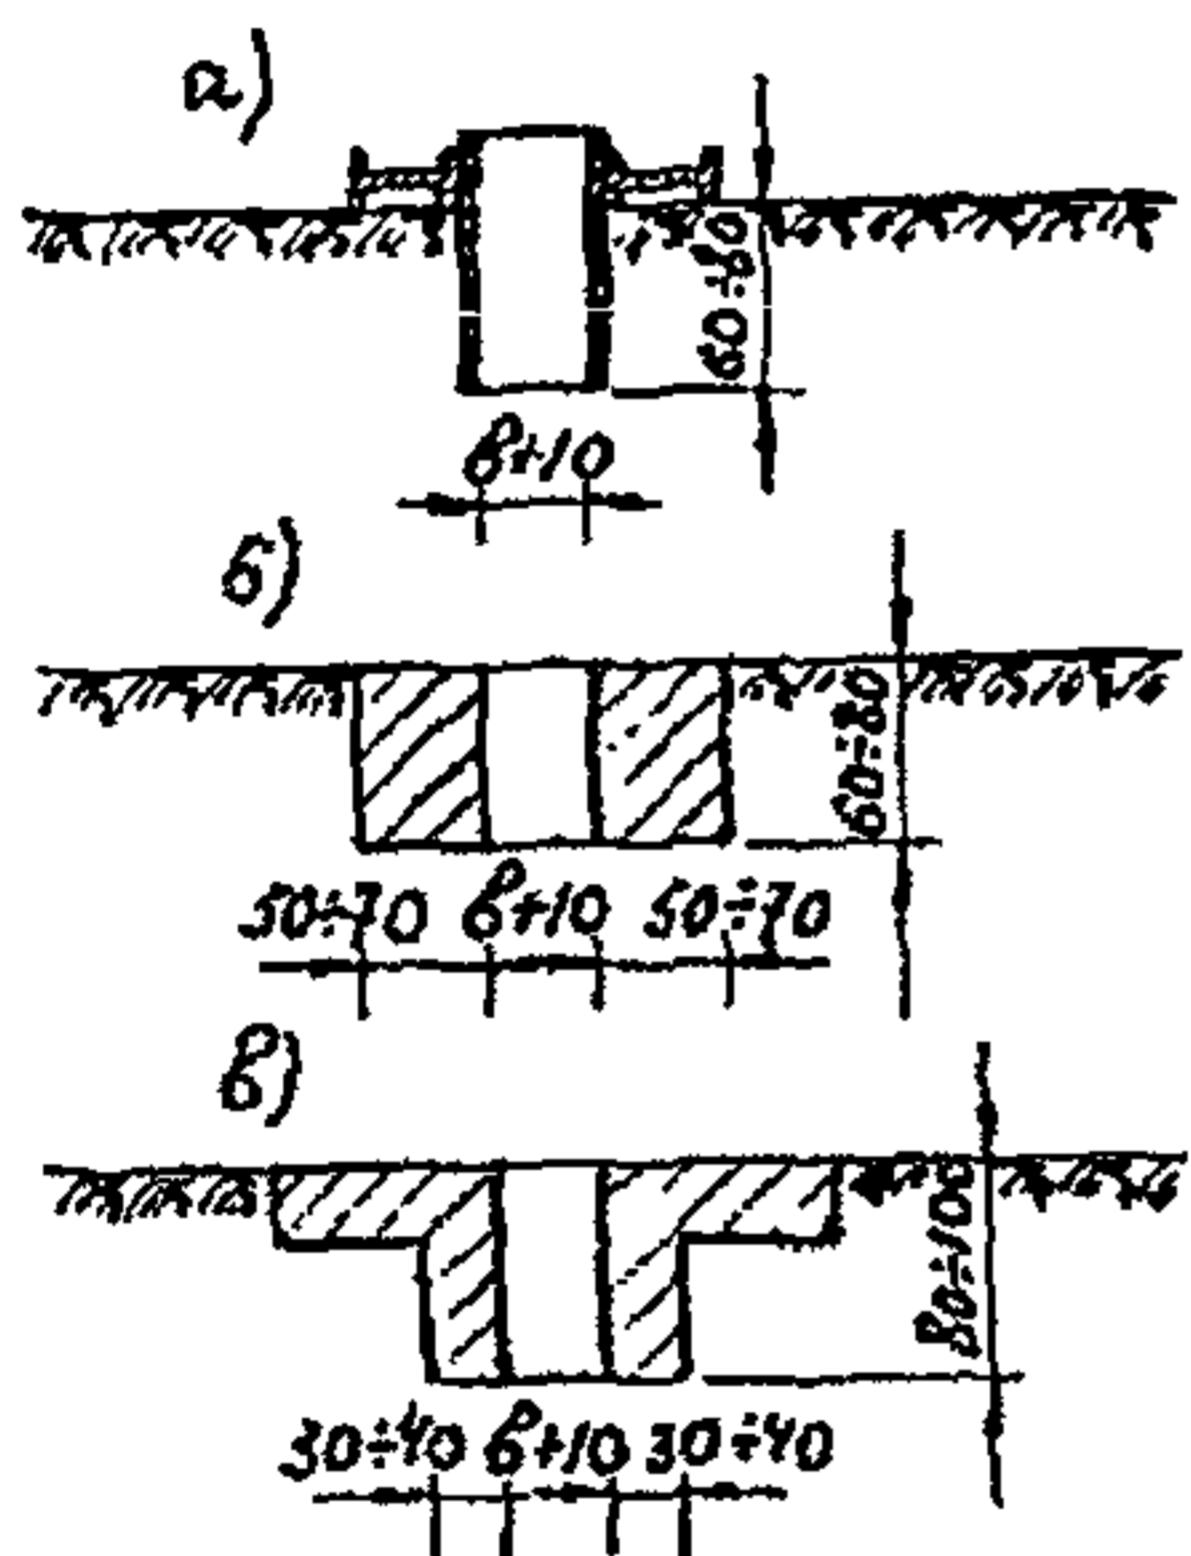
Конструкции воротников: а - металлический; б - бетонный; в - железобетонный (в - ширина грейфера; на рисунке размеры даны в см)
